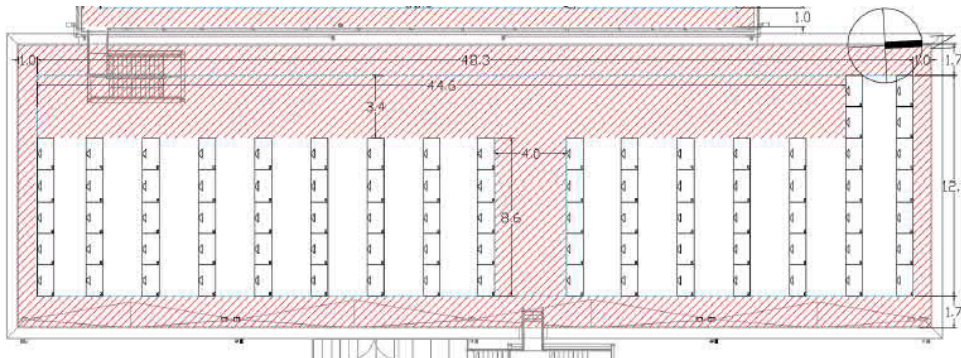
Dachfläche B-1/B-2; je Dachfläche ca. 85 Module, je Dachfläche ca. 34 kWp, Neigung 35°
